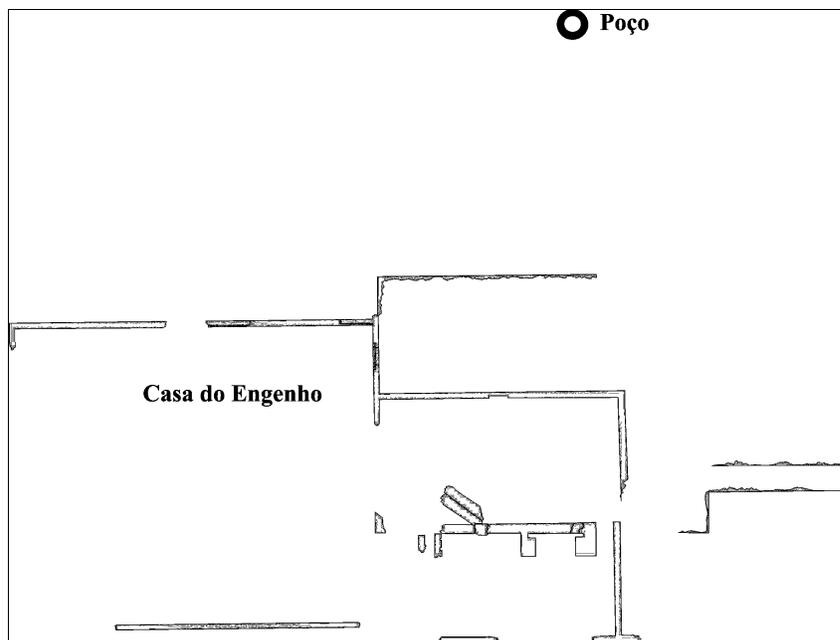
Planta baixa da área da casa do engenho, cujas dimensões são bastante similares com as dos grandes galpões utilizados nas fábricas como casa de purgar.
